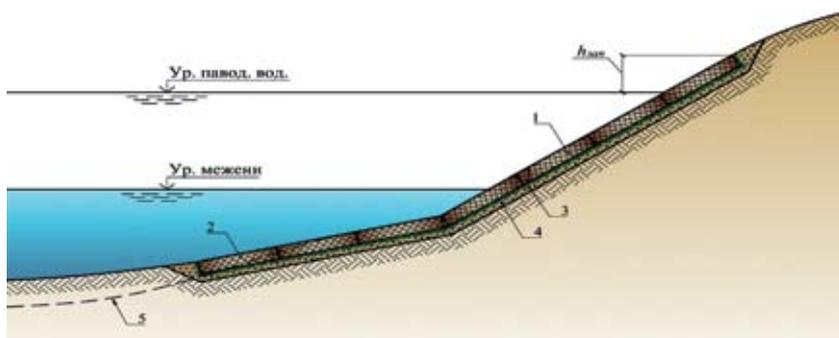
Укрепление размываемого берега реки (вариант №1)
